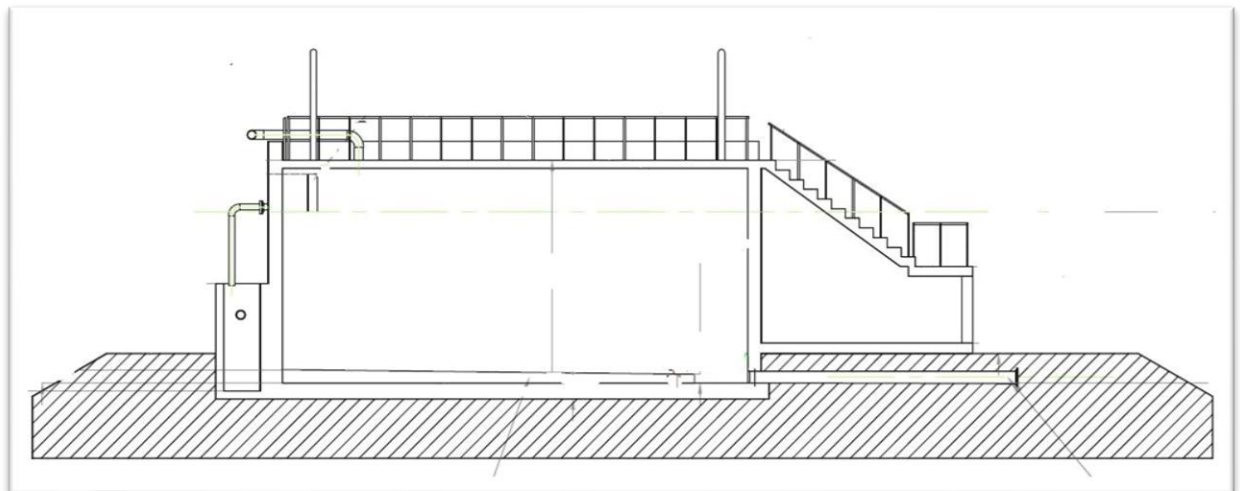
Vista en corte transversal del tanque almacenador de lodos. Fuente OPISU.
